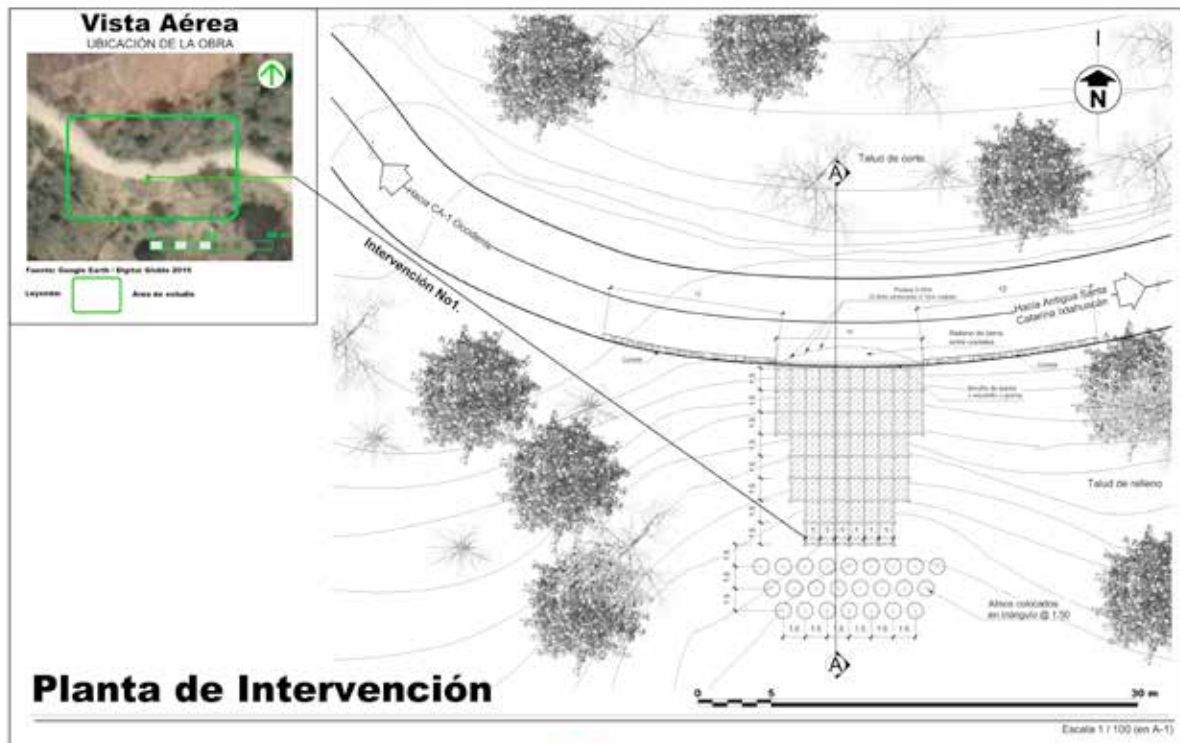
Planta de intervención. Planificación Obra ORCC-02/RD-SOL-02 y RD-SOL-13.
